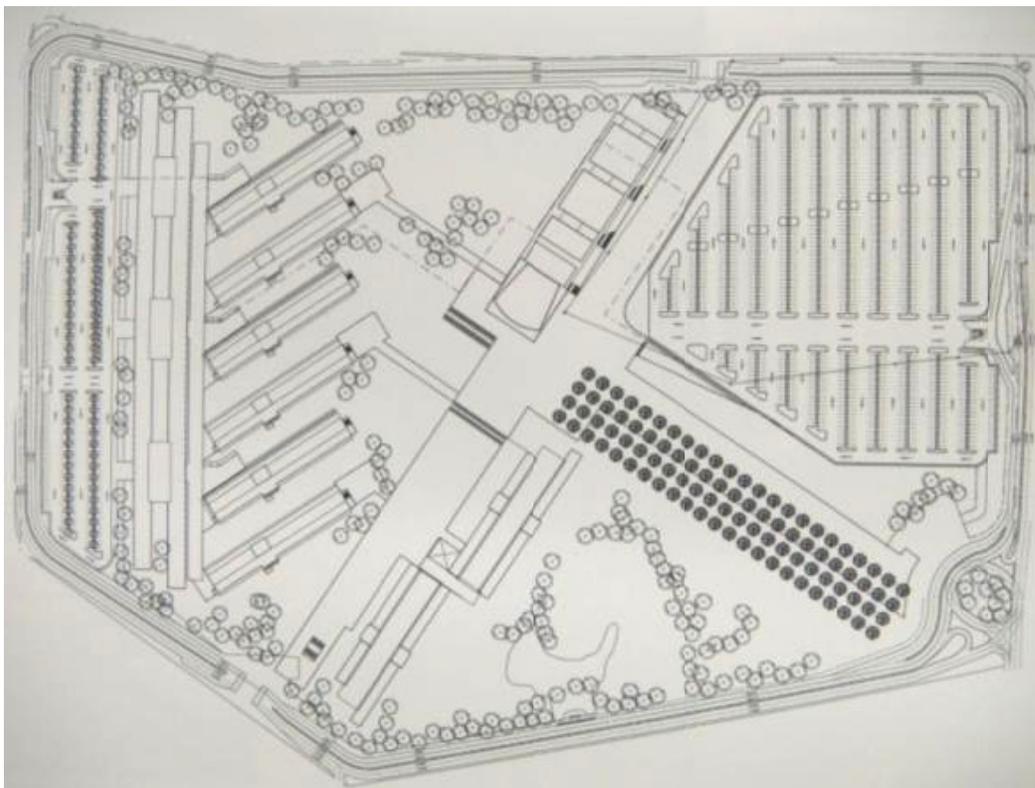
Planta de Conjunto, proyecto completo. Fuente: CPVFACARQ.
